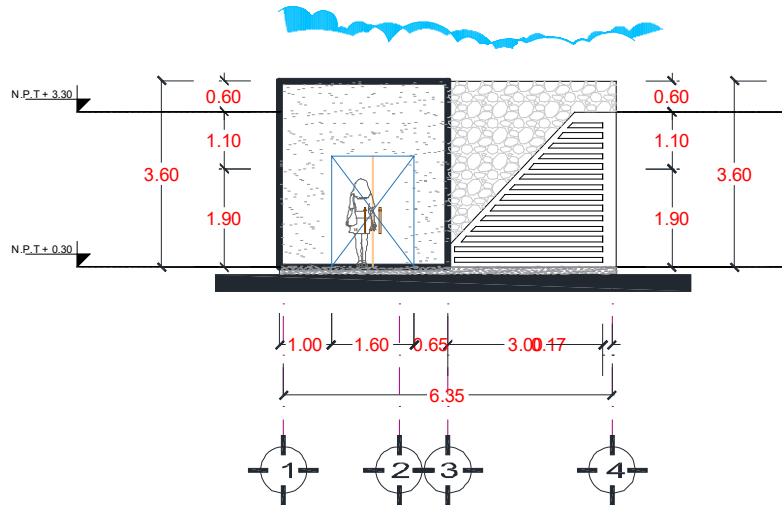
Propuesta Taller, Fachada suroeste (Anexos Plano: 10- FACH-TALLER-01)
